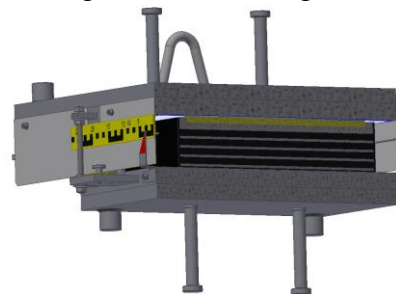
Lagertyp VG2, mit Elastomer Typ E, für beidseitigen Betonanschluss (hier im Schnitt dargestellt)
